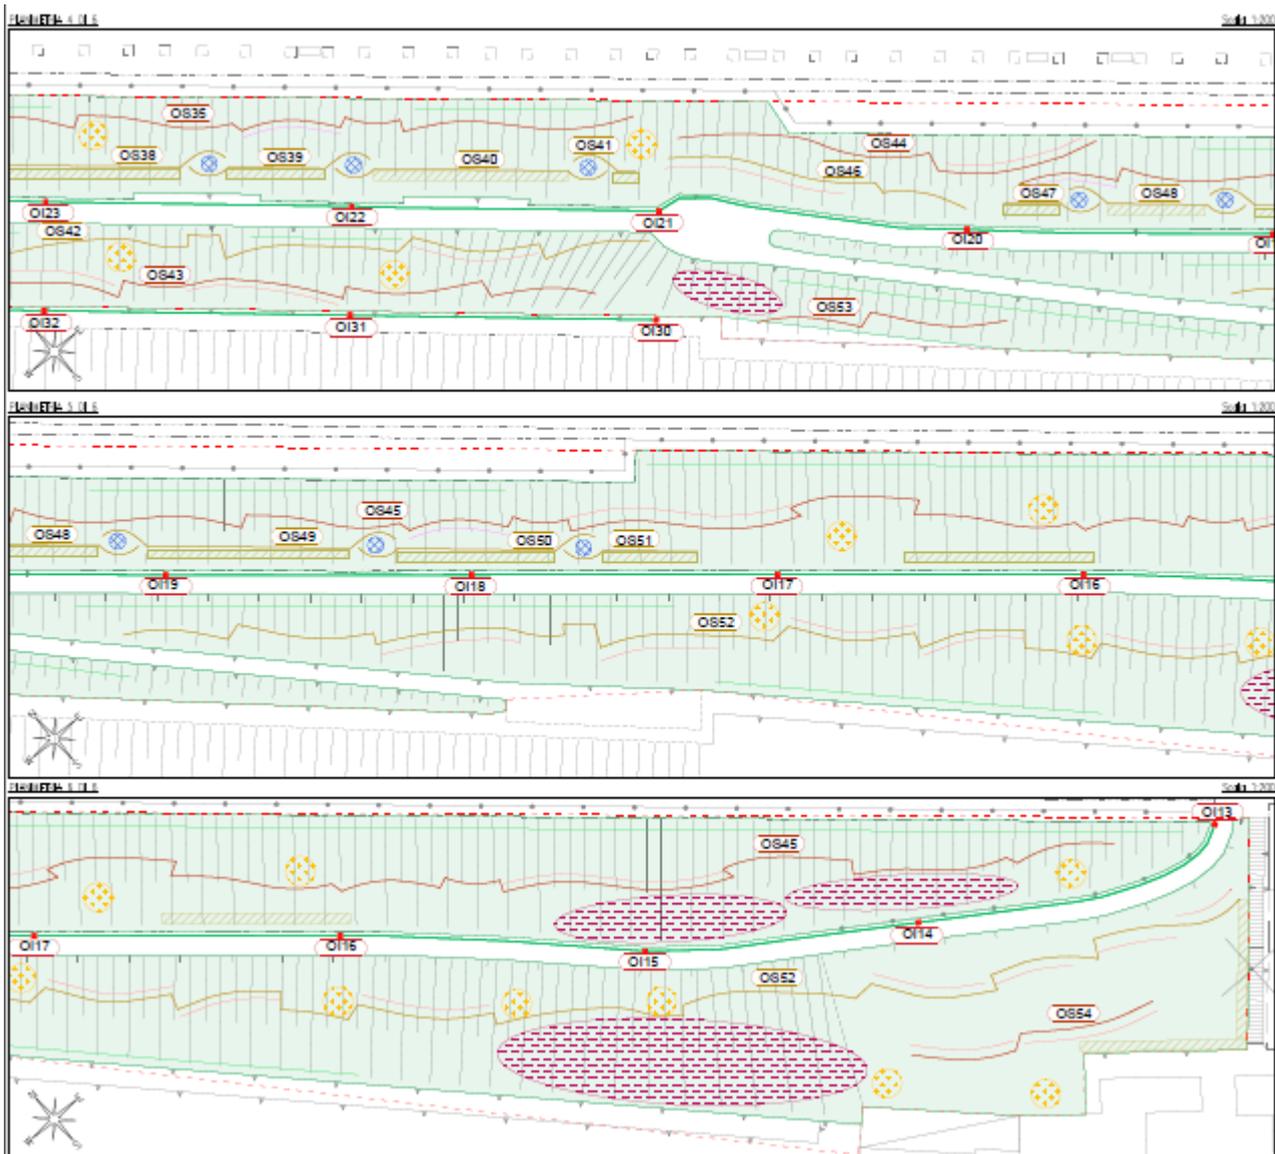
Estratto elaborato Planimetria generale di progetto (2 di 2)
